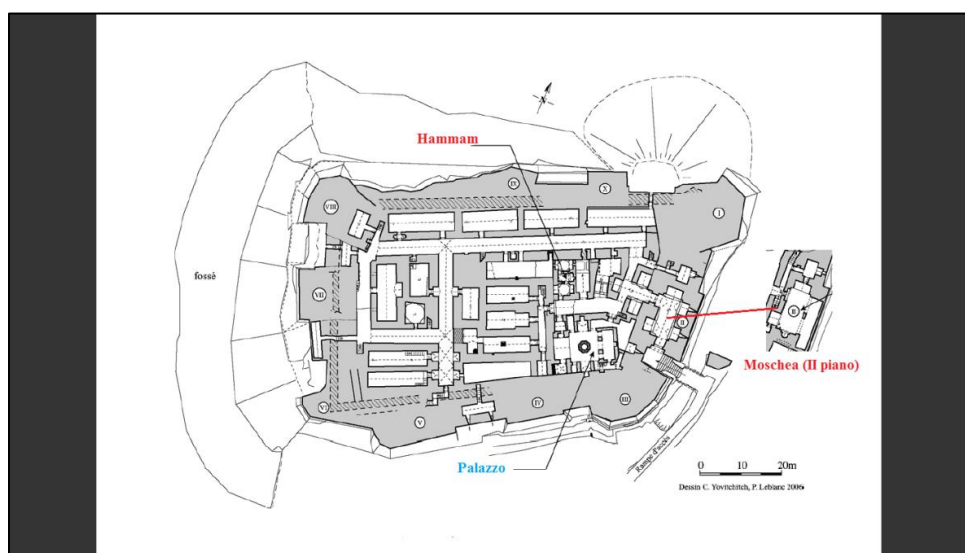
Qal'at Najm, pianta del castello (tratto da Yovitchitch 2011, figg. 2-3)
